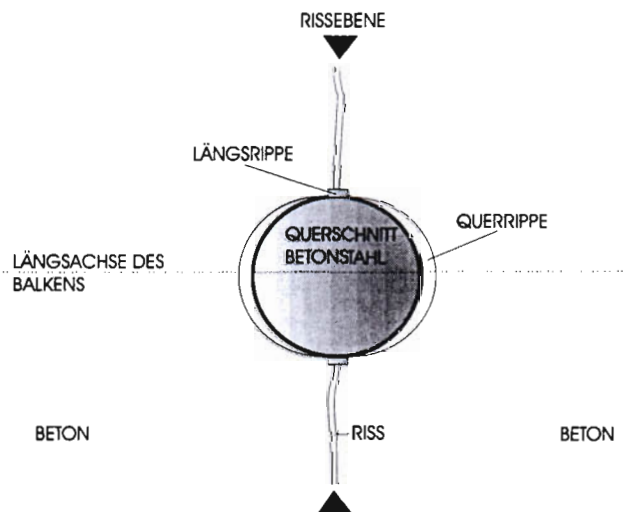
Ausrichtung der Rippenmitten des Betonstahles in Balkenlängsrichtung
